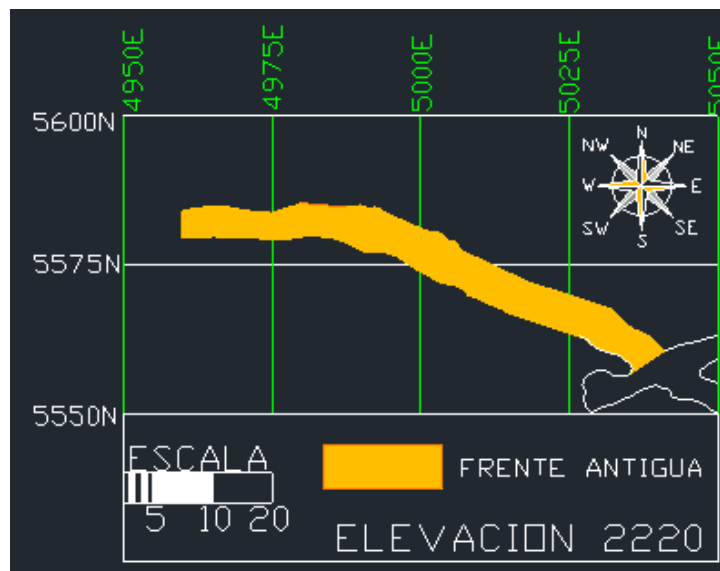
Vista en planta de la frente principal de extracción (debajo del B-2200)
